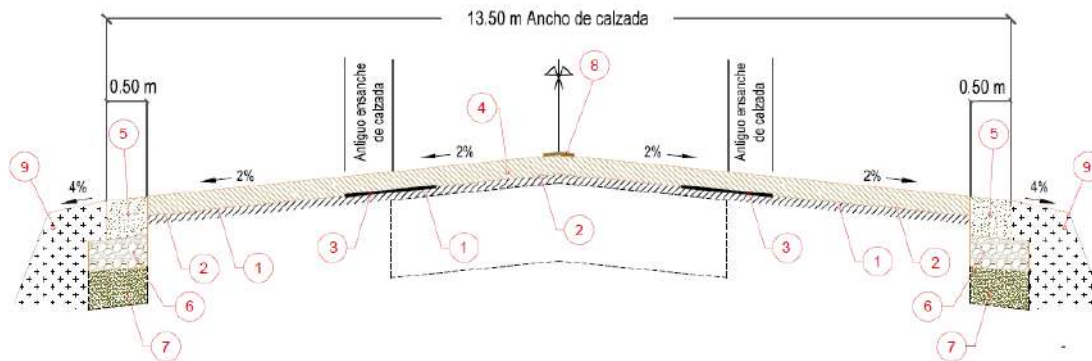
Planimetría de Proyecto RPN°205 (5)
